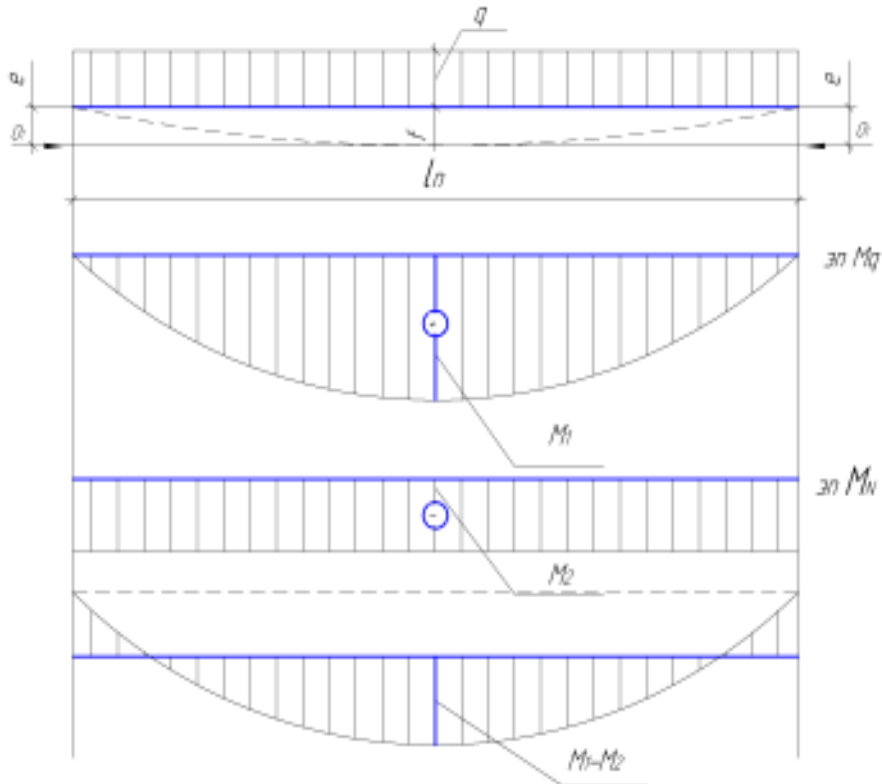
Расчетная схема панели верхнего пояса
